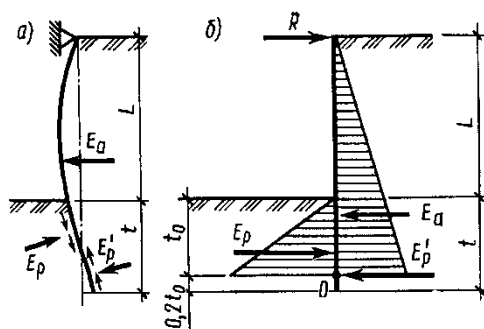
Расчет заанкерной стенки по схеме Блума-Ломейера:
